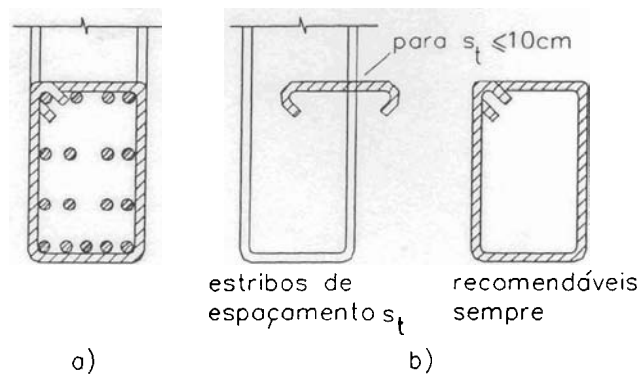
Arranjos de estribos para barras tracionadas emendadas [FUSCO, 1994]
